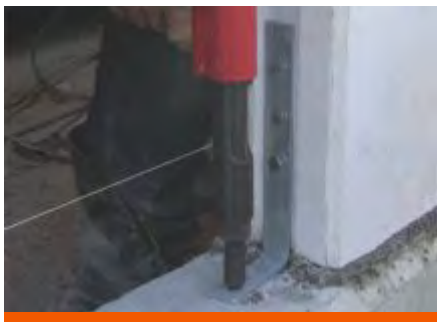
Fijar el conector a la viga de apoyo de concreto.
